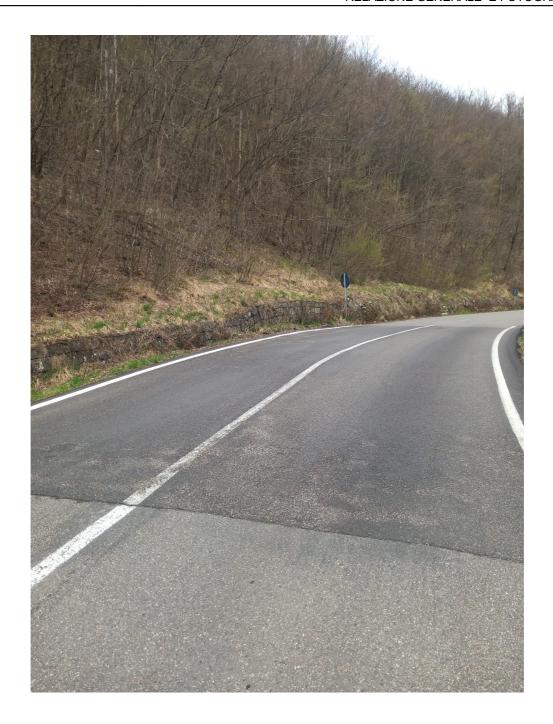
vista della SP 9 nel tratto interessato dal dissesto (da monte)
